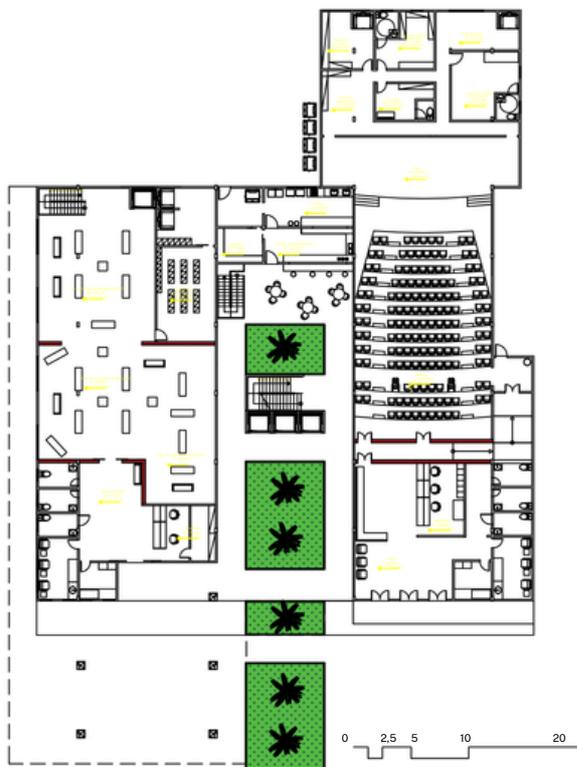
Planta baixa térreo. Fonte: Elaborado pelo autor
